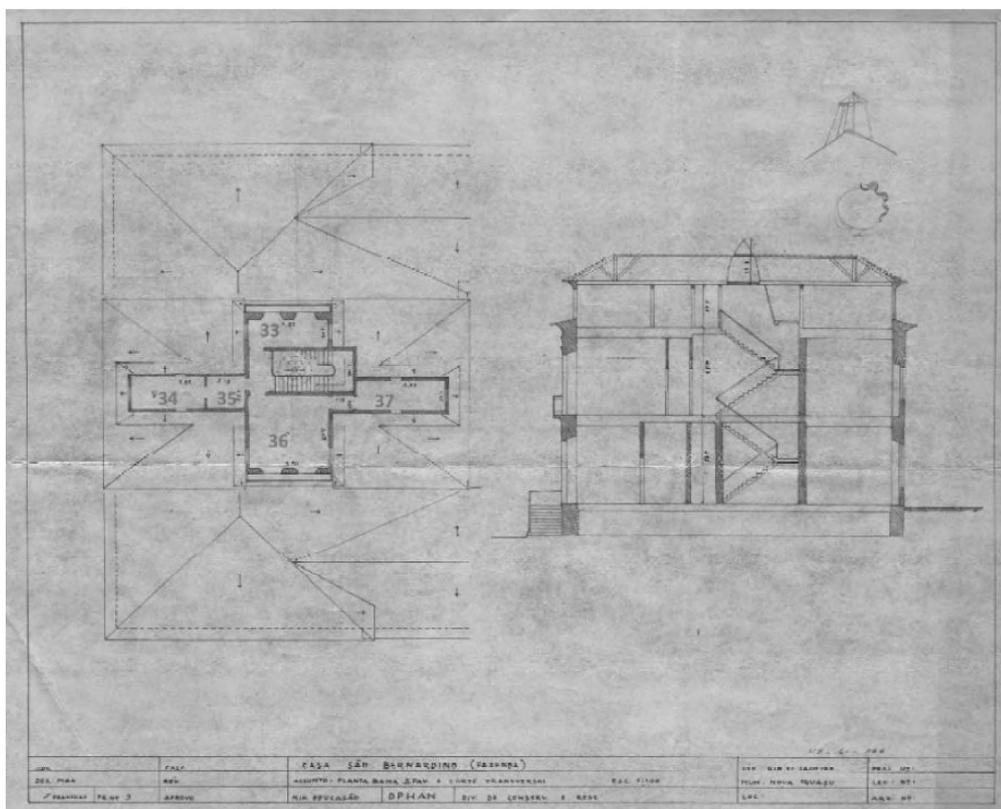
Planta baixa do 3º andar e corte lateral.<sup>24</sup>
